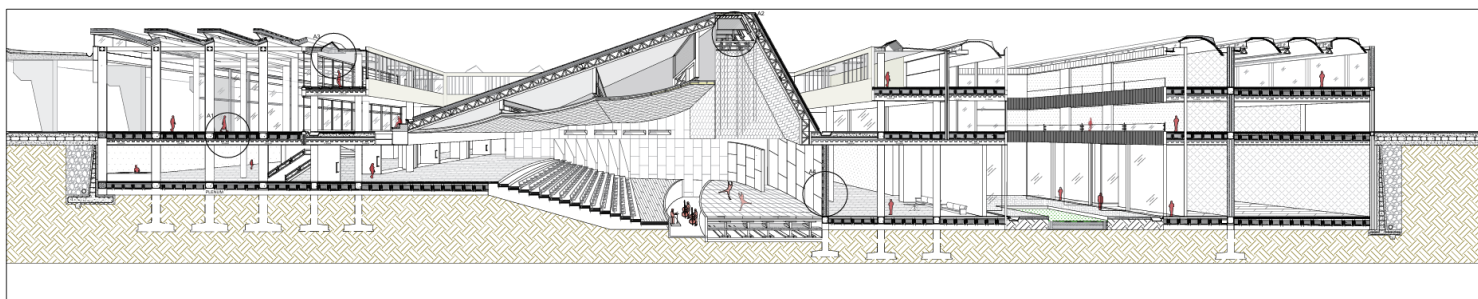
Corte Fugado Longitudinal / Proyecto Arquitectónico
